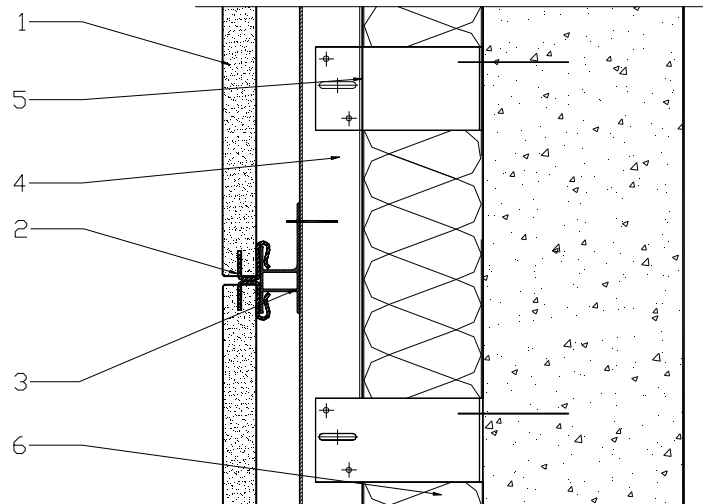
Principe de montage coupe verticale pour des plaques de hauteur > 1 m
